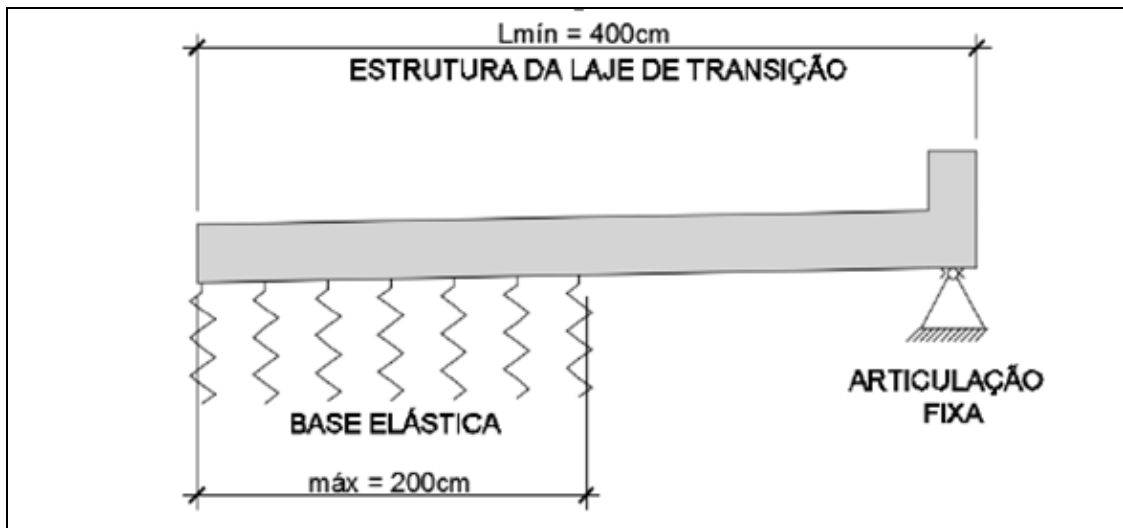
Modelo de Cálculo Para Laje de Transição – kN.m/m
